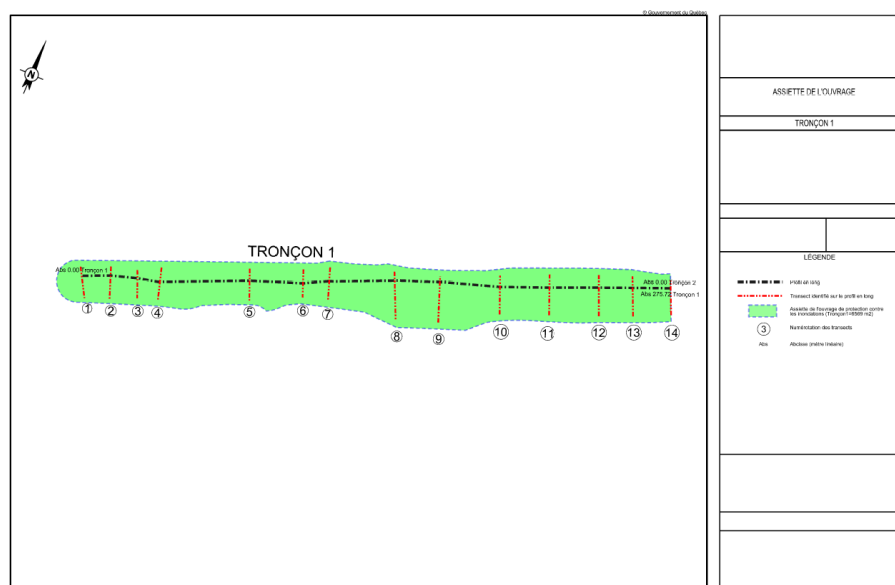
Exemple d'un plan d'un tronçon d'un OPI.
